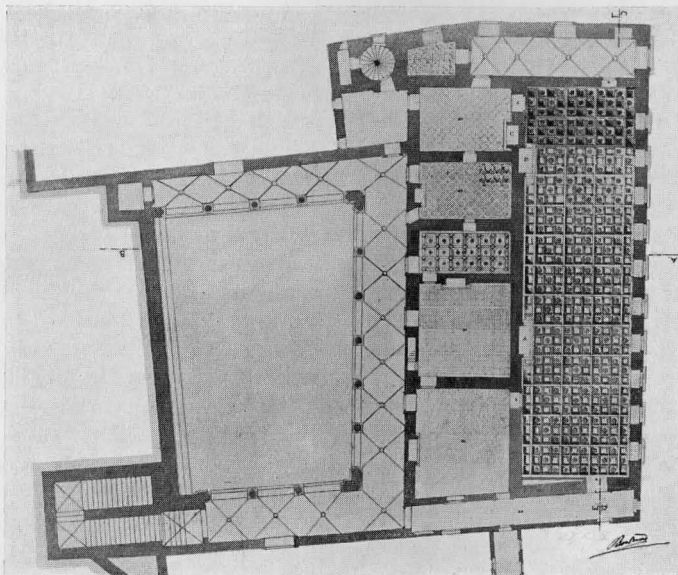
GUBBIO, PALAZZO DUCALE: PLANIMETRIA
